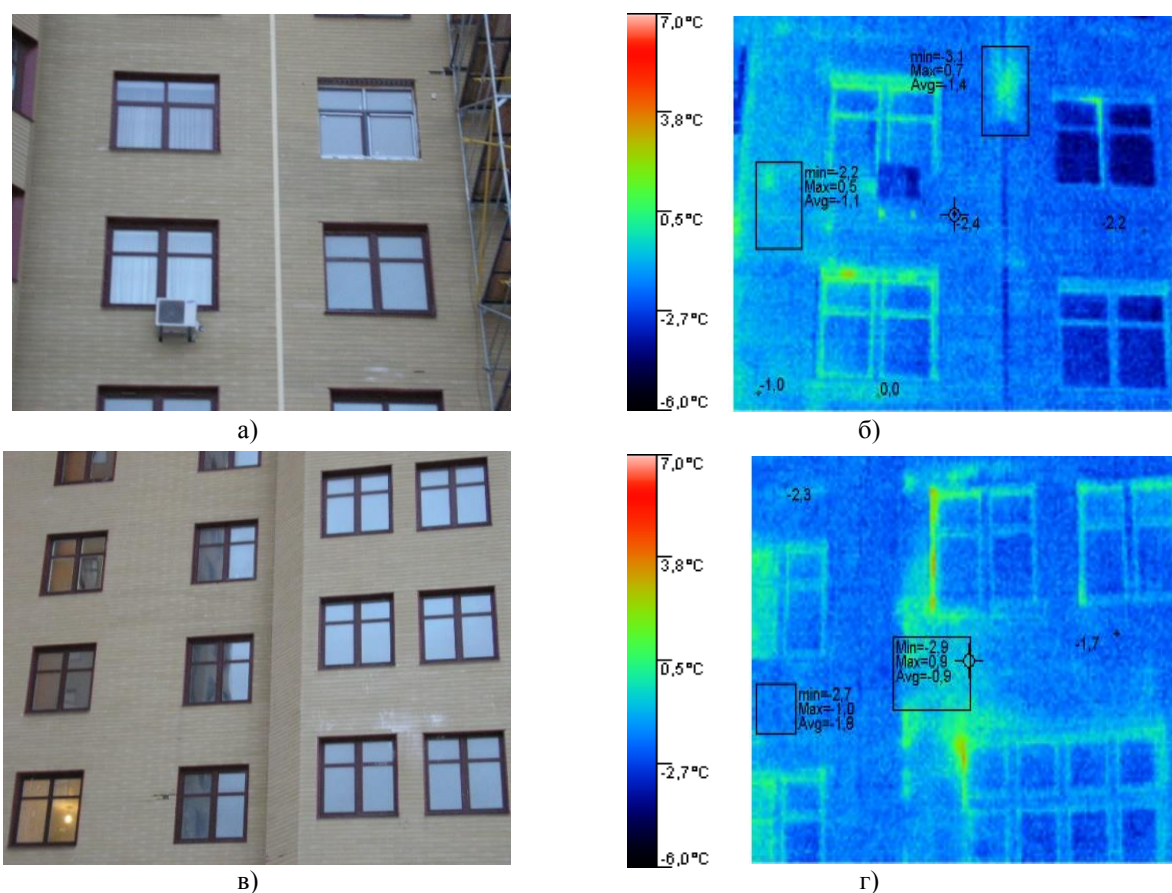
Жилое здание, построенное в г. Киев, утепленное вентилируемым фасадом
